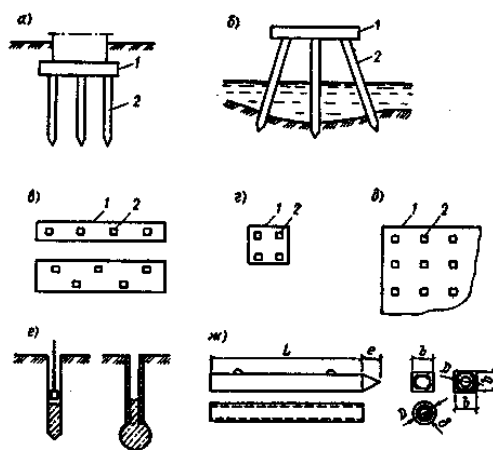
Типы свайных фундаментов и свай: а – фундаменты с низким ростверком; б – фундамент с высоким ростверком; в – ленточные фундаменты; г – свайный куст; д – свайное поле; е – набивные сваи; ж – железобетонные сваи; 1 – ростверк; 2 – свая.
